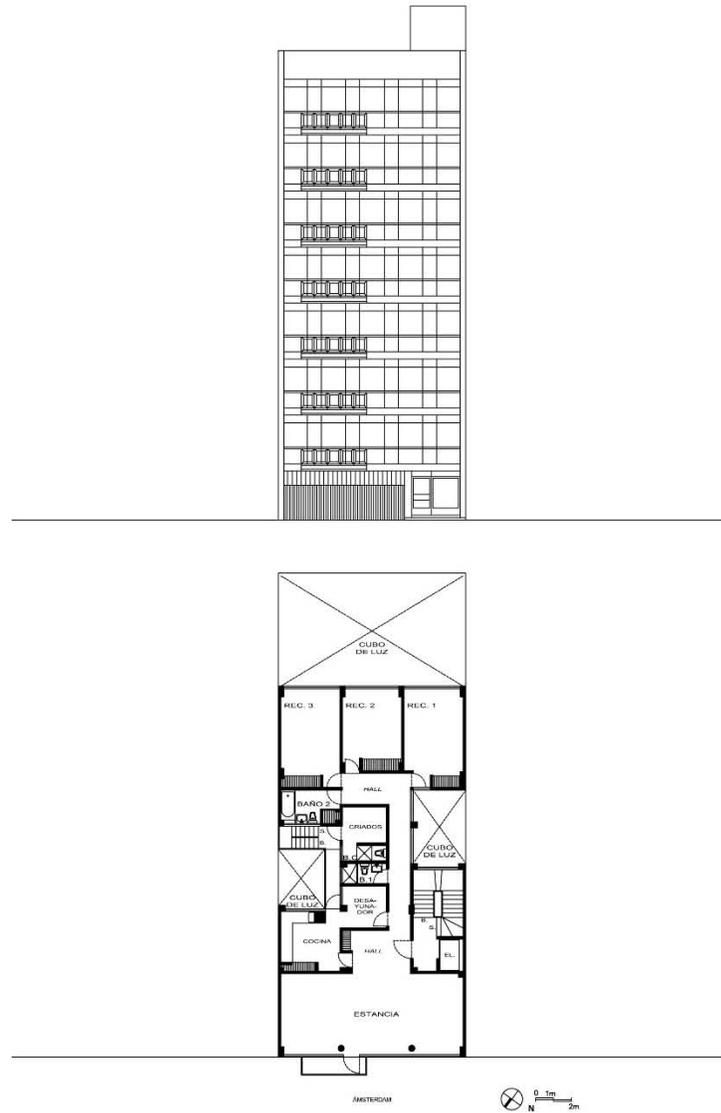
Fachada y planta del edificio ubicado en Ámsterdam núm. 122
